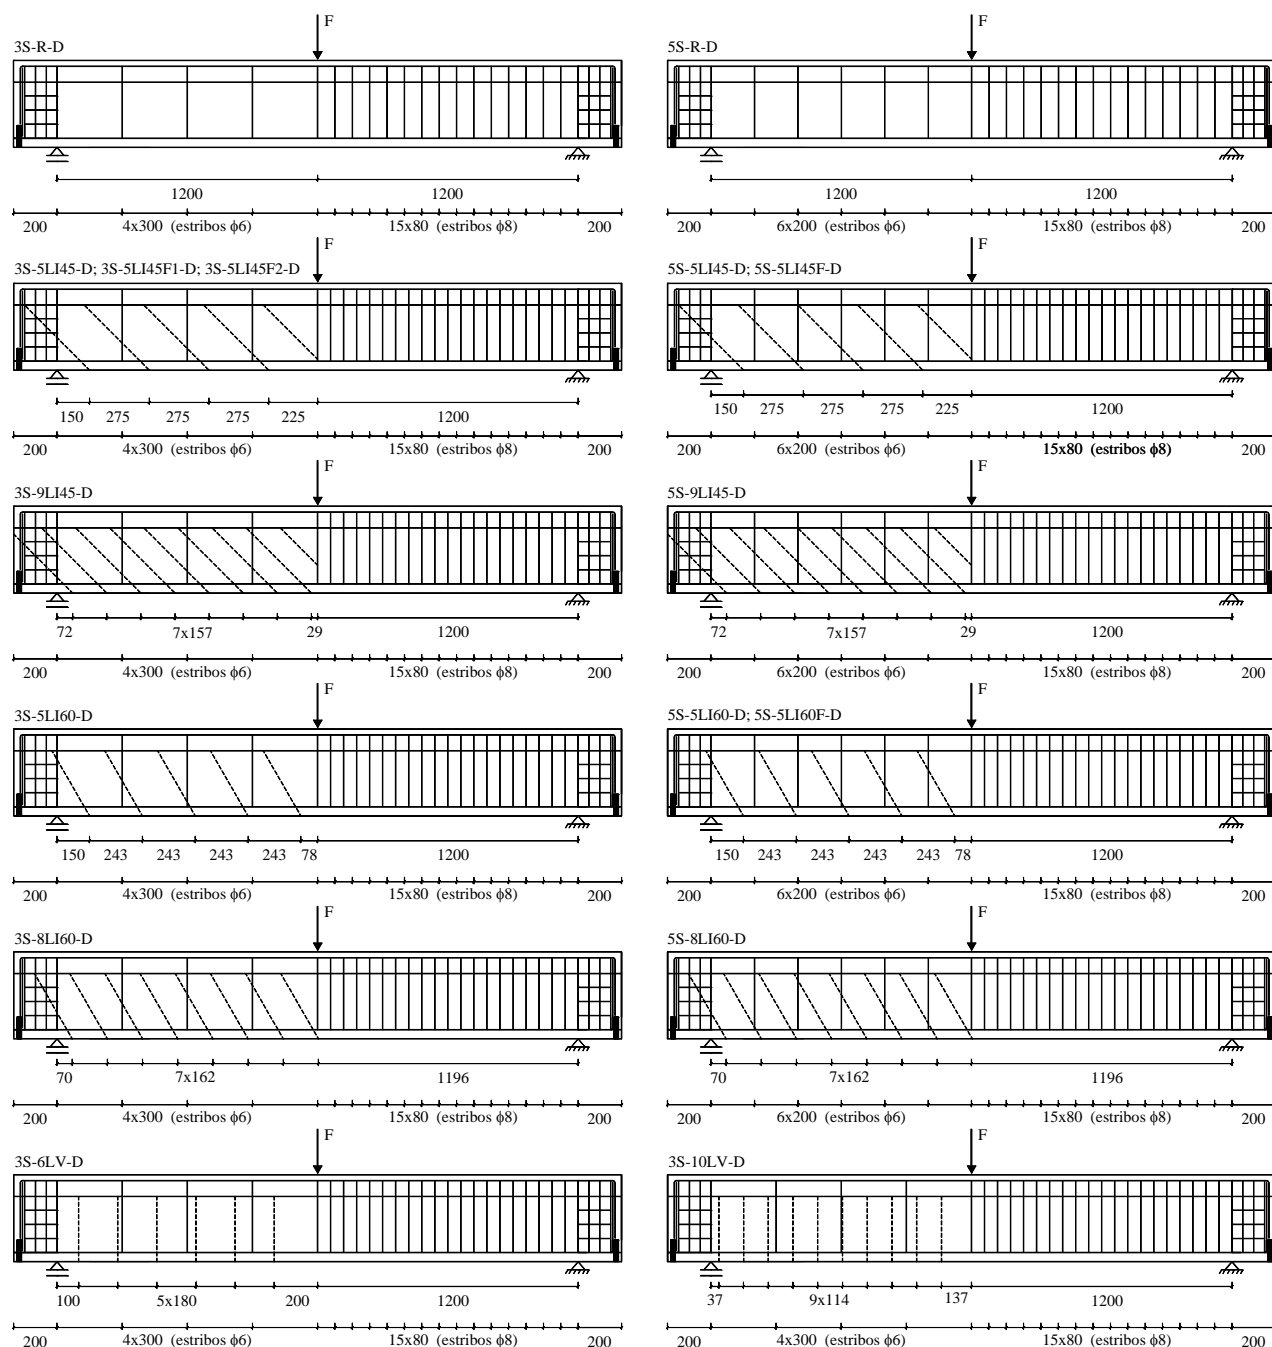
Vigas ensaiadas da série D: localização das armaduras transversais (linha a traço cheio) e dos laminados de CFRP no reforço ao corte (linha a tracejado).
